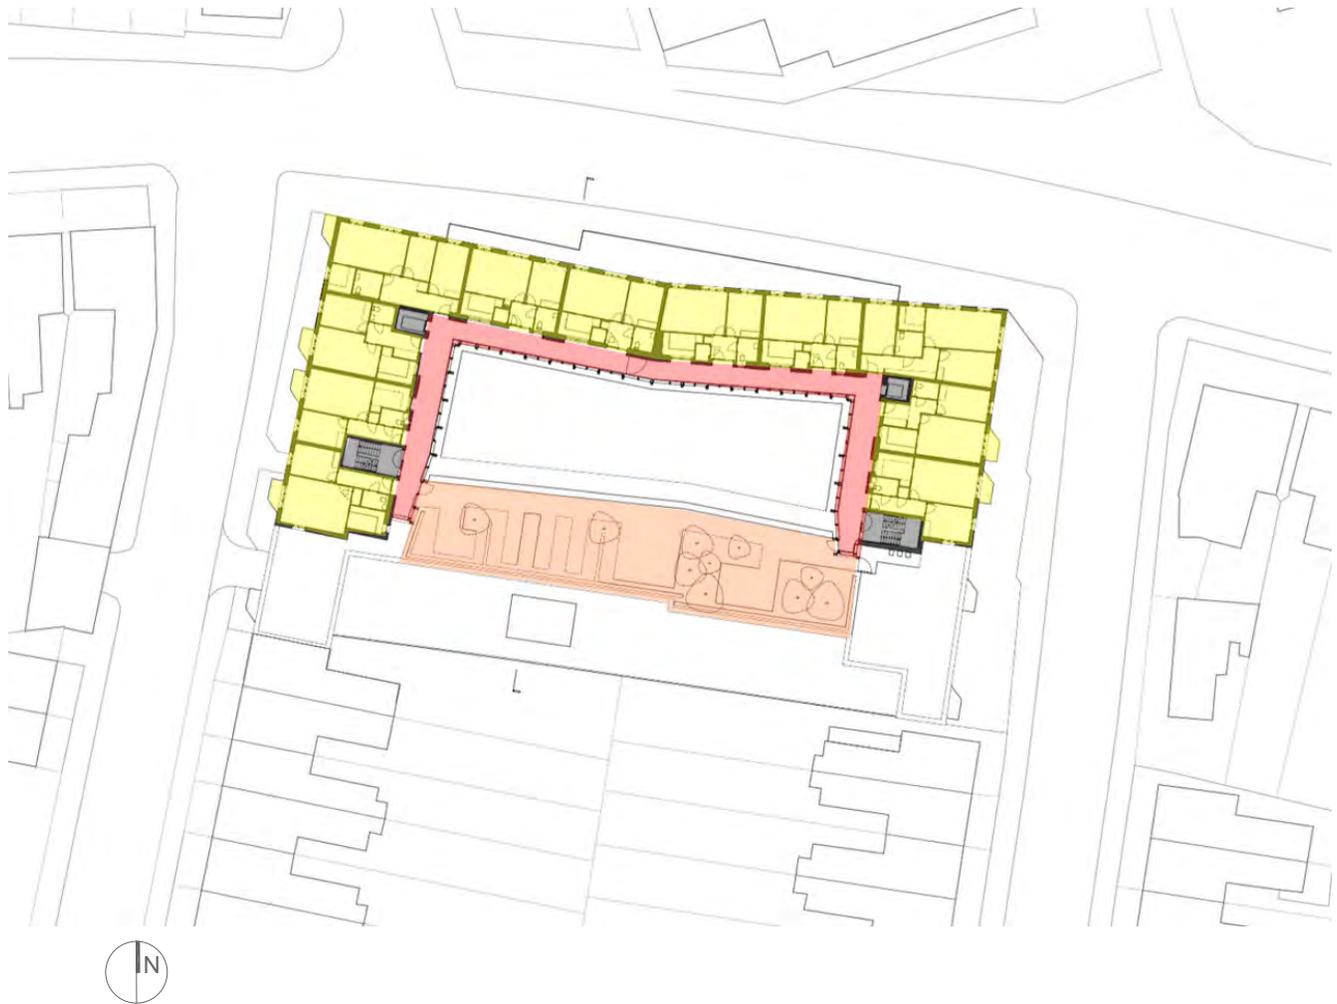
Almshouse. Planta Tipo Habitaciones.
